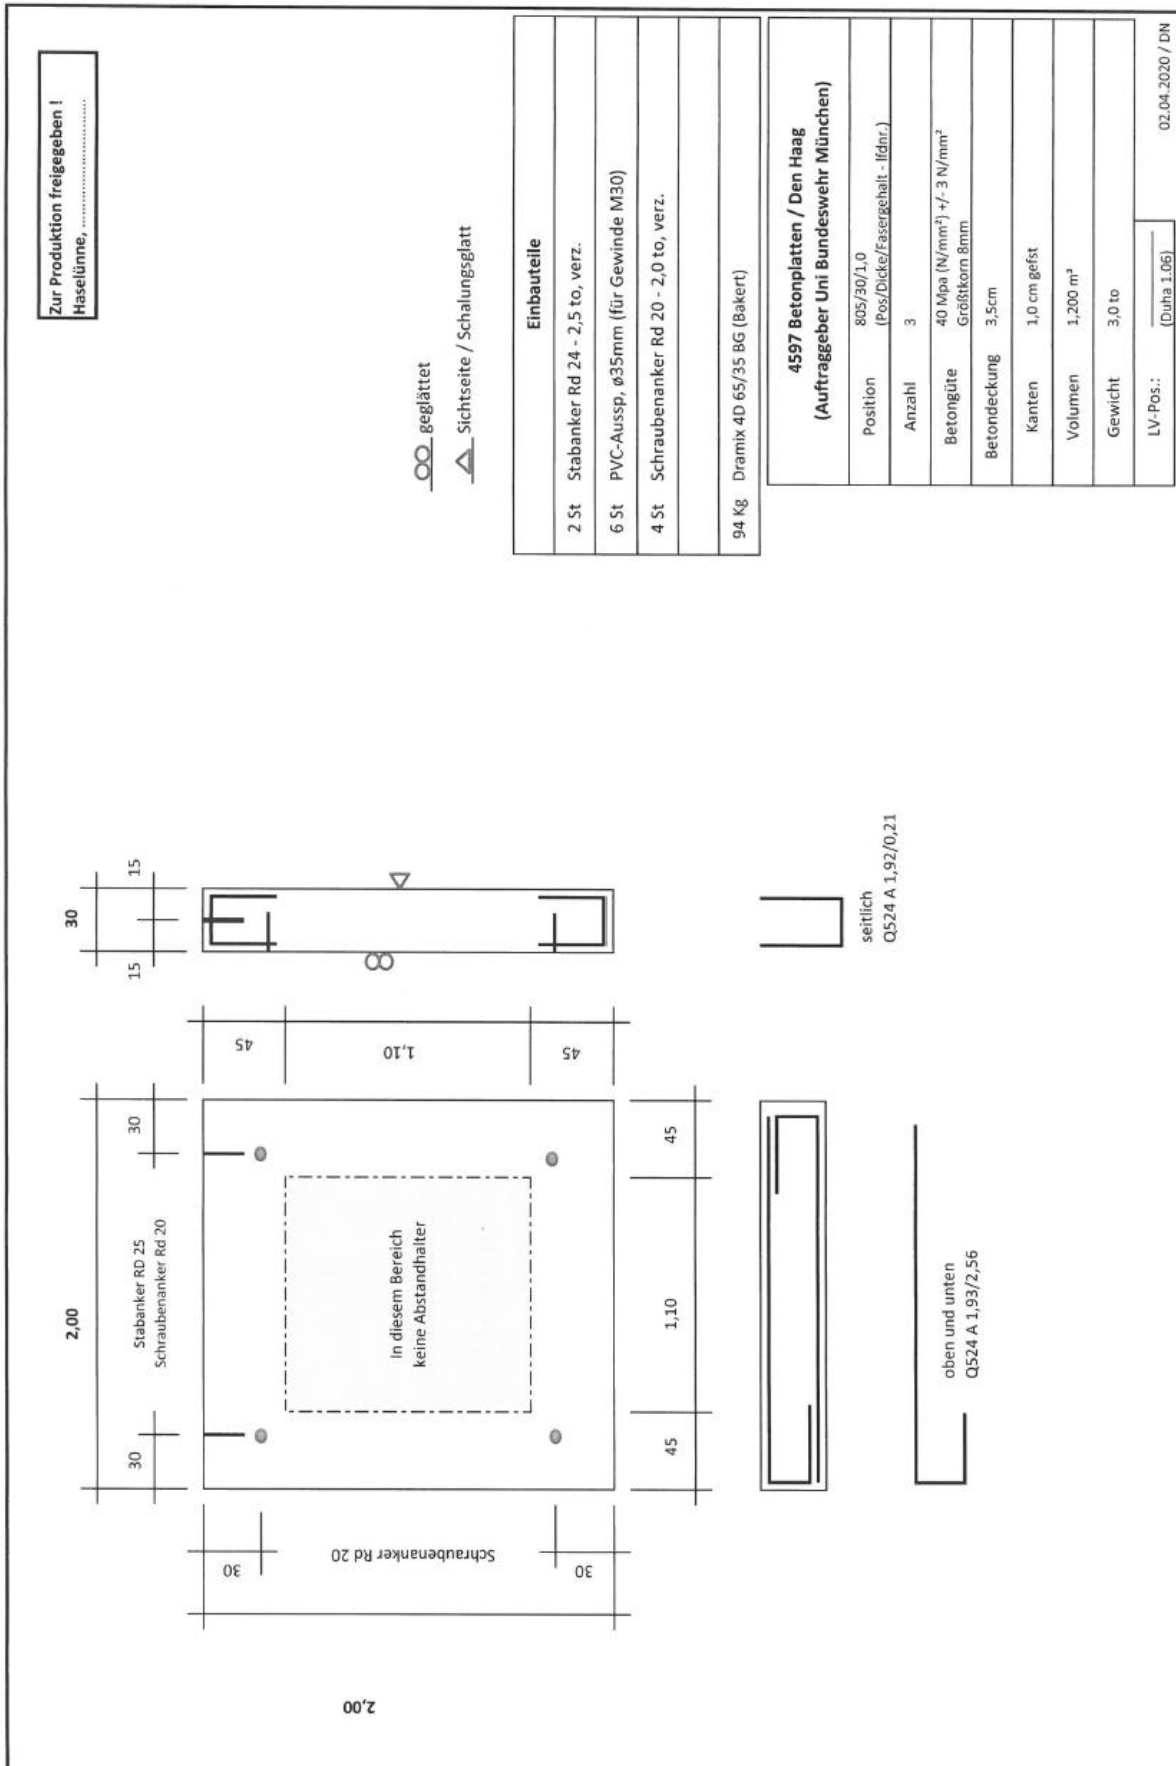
Bewehrungsplan für Stahlfaserbetonplatte mit 1,0 Vol.-% Fasergehalt.
